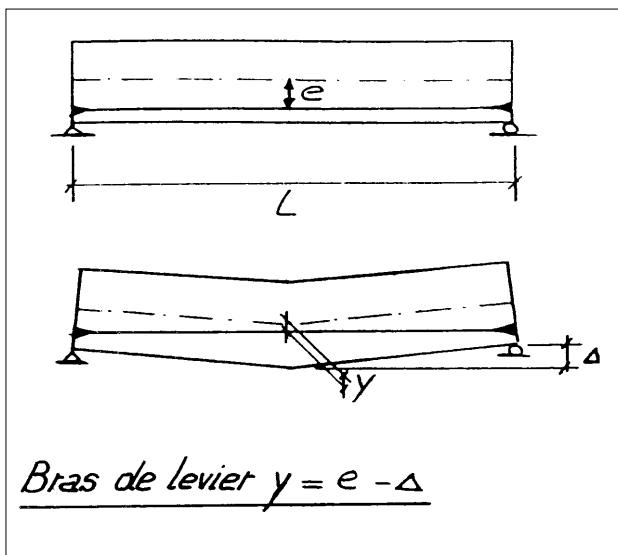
Influence de la déformation d'une poutre sur l'excentricité d'un câble rectiligne lié à la structure par les seuls ancrages.
